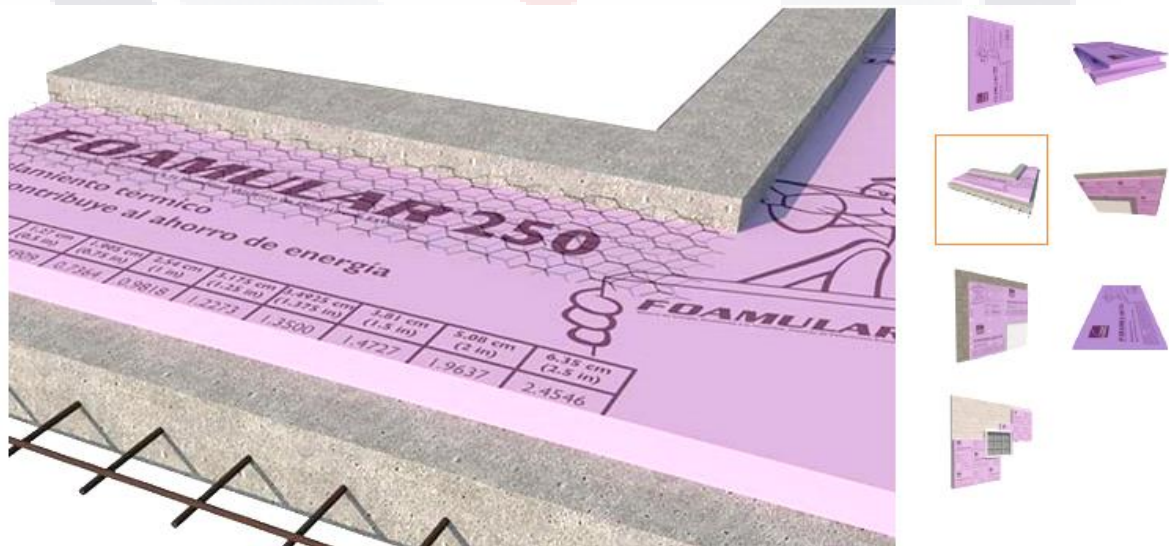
Detalle constructivo para paneles de poliestirenos extruidos Owens Corning- Panel Foamular 250- 1" Fuente: (Owens Corning México, 2019)
